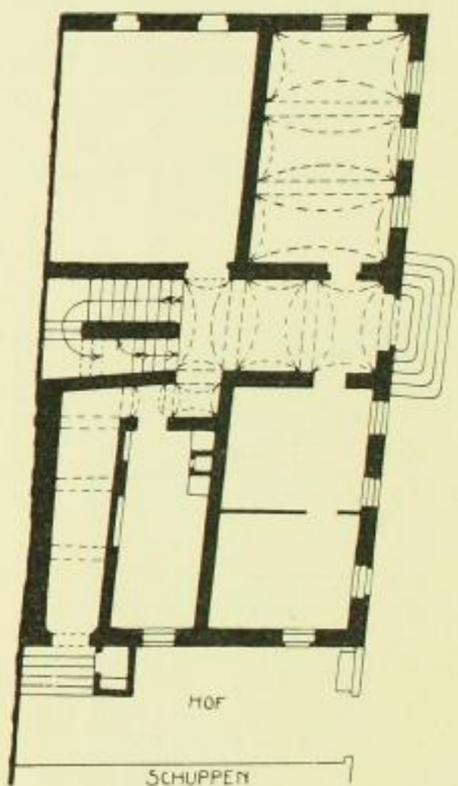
Ecke Töpferstraße u. Görlitzer Straße, Grundriß.
